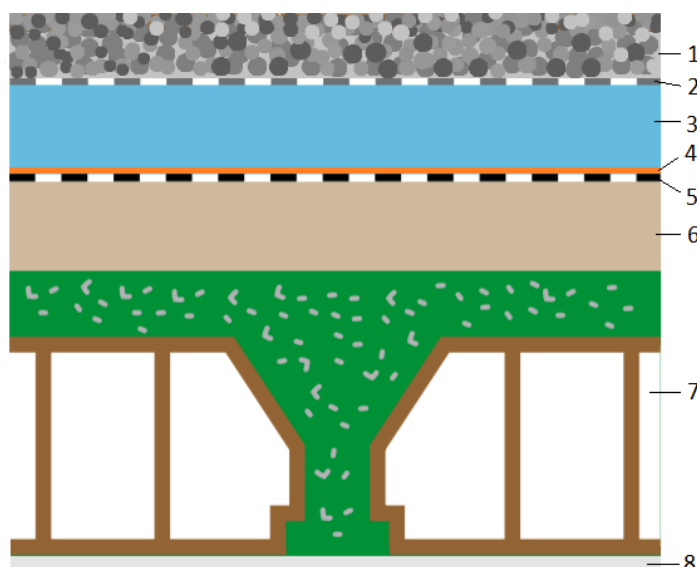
Sección cubierta plana invertida con acabado de grava.
